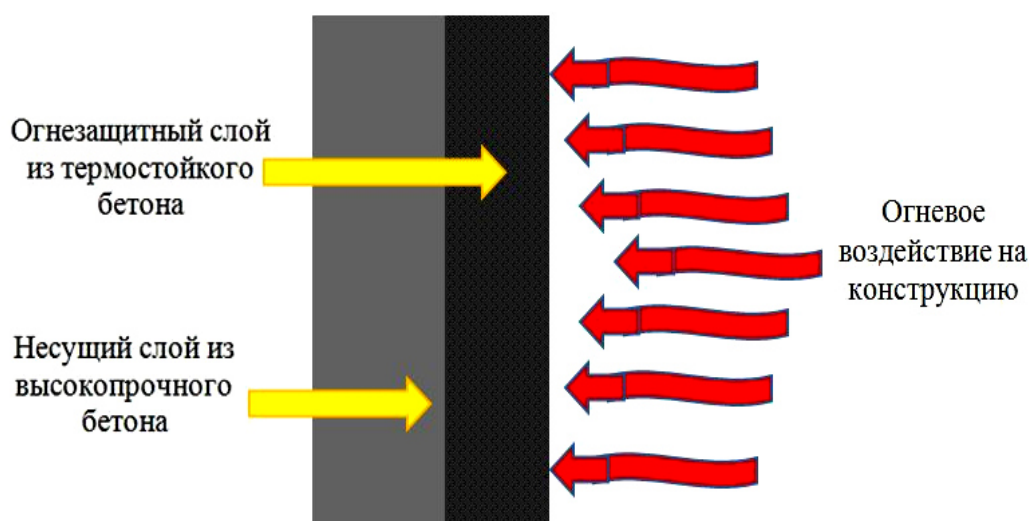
Схема двухслойной огнестойкой железобетонной конструкции с применением высокопрочного бетона, модифицированного комплексной ОМД [7, 19]
